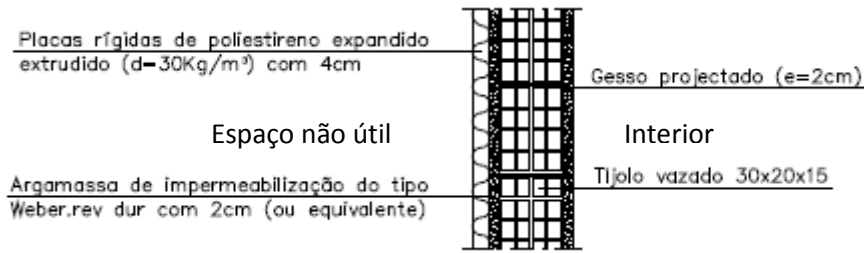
Pormenor construtivo da parede Pi3 [17]
